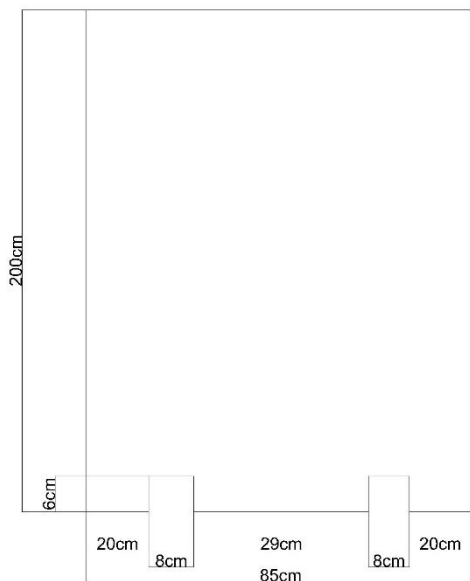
Vista lateral de plancha de policarbonato, Elaboración propia
